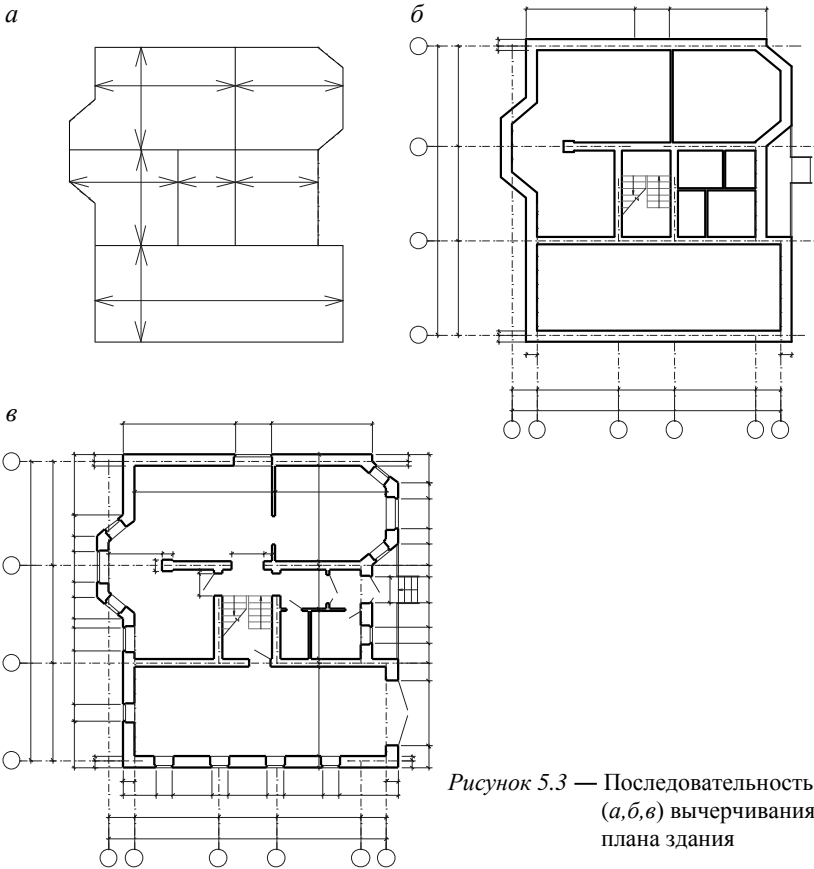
Последовательность (а, б, в) вычерчивания плана здания
